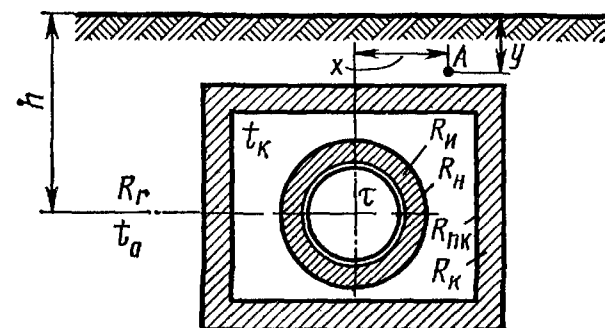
Расчетная схема однетрубного теплопровода канальной прокладки
